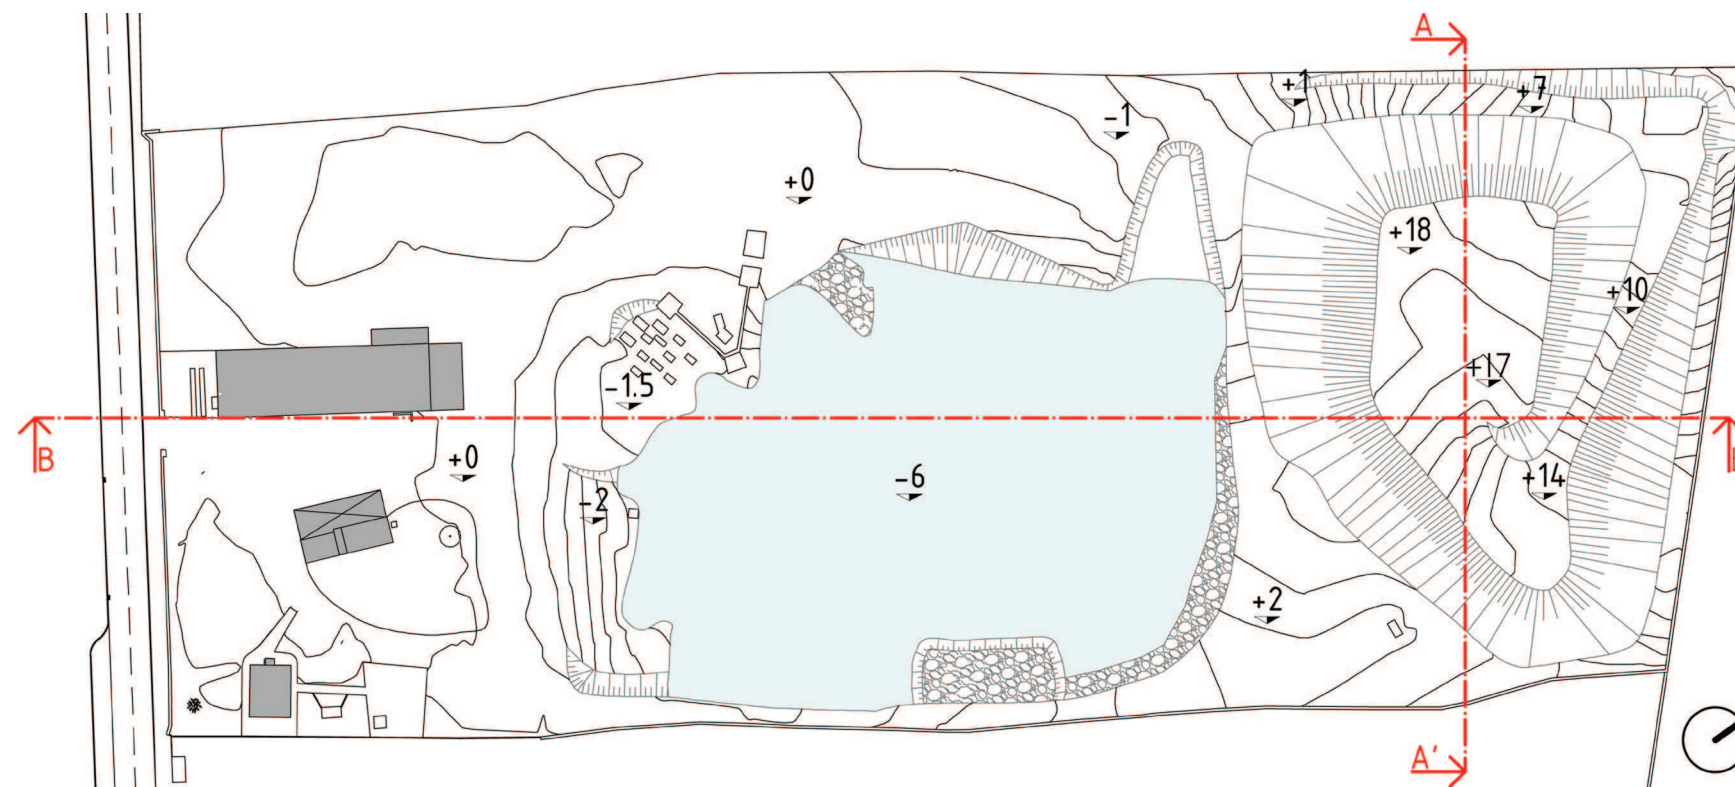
\_Planimetria sito di progetto prima dell'intervento
